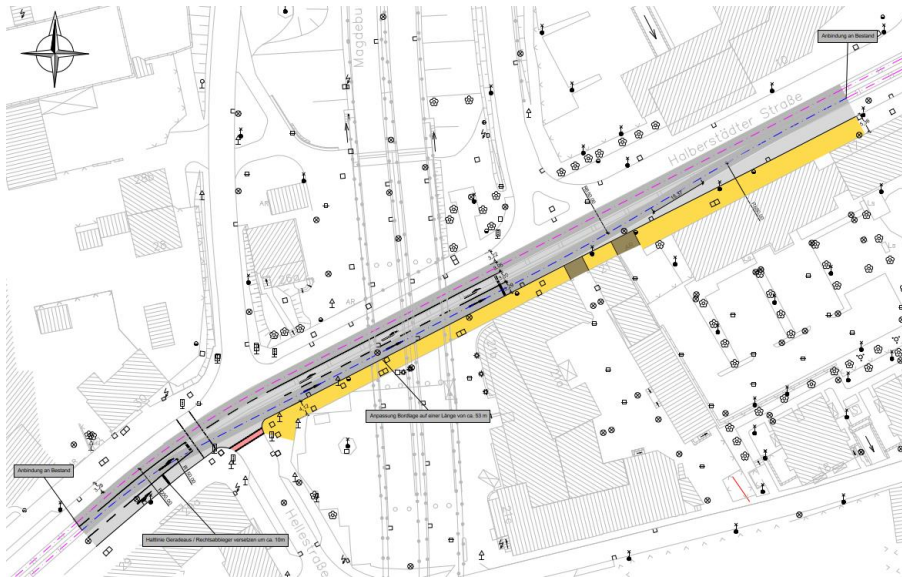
Lageplan Maßnahme I7 Variante 1
